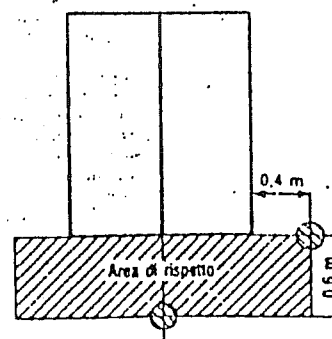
Area di rispetto per apparecchi a tiraggio forzato (commi a e b del prospetto precedente)
